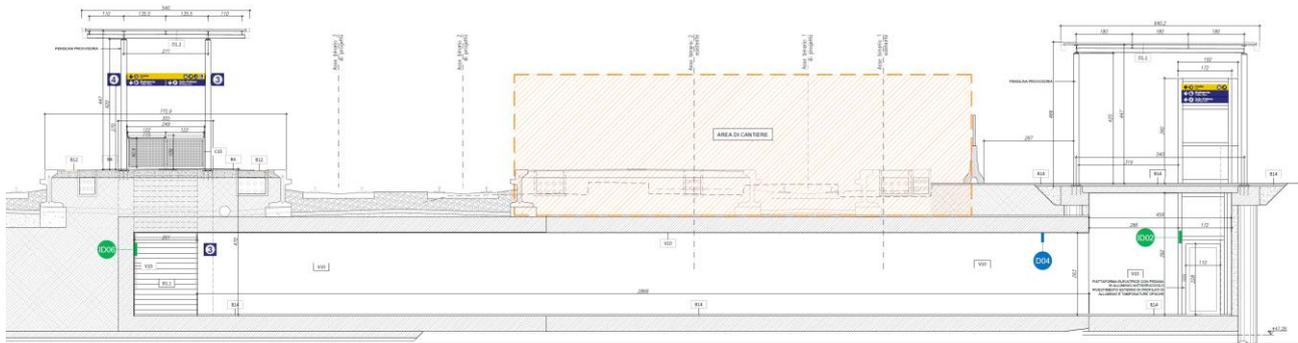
Sottopasso provvisorio – Sezione longitudinale
